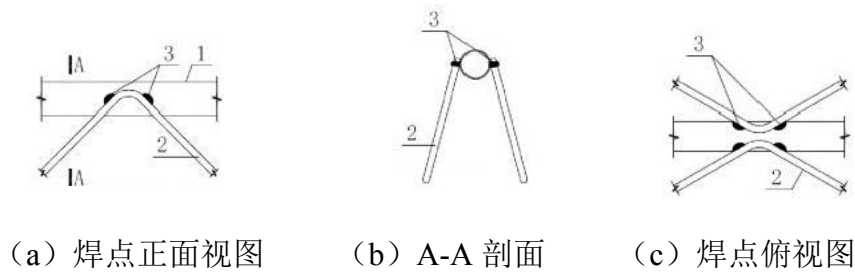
腹杆钢筋与钢管焊接示意图
